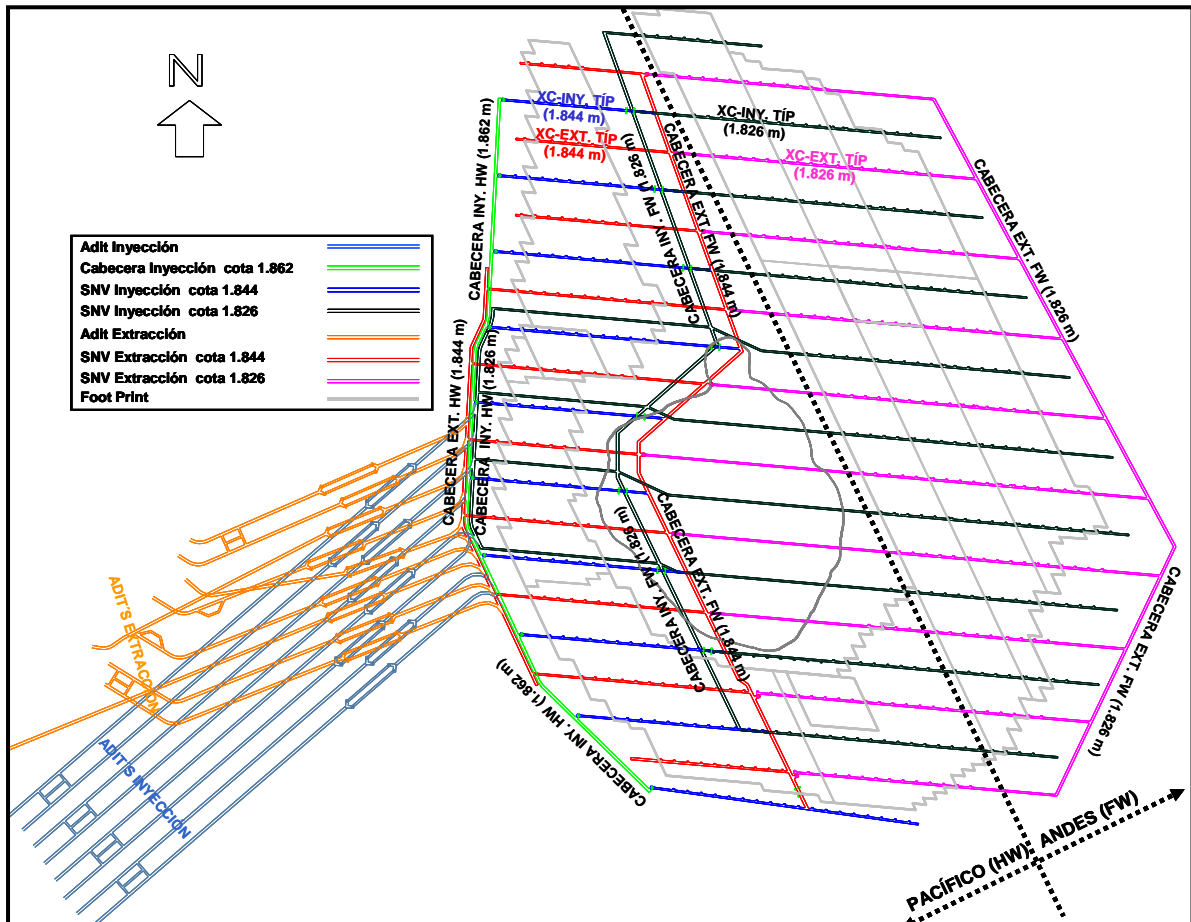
Layout Ventilación Principal y Secundaria (Inyección y Extracción)
